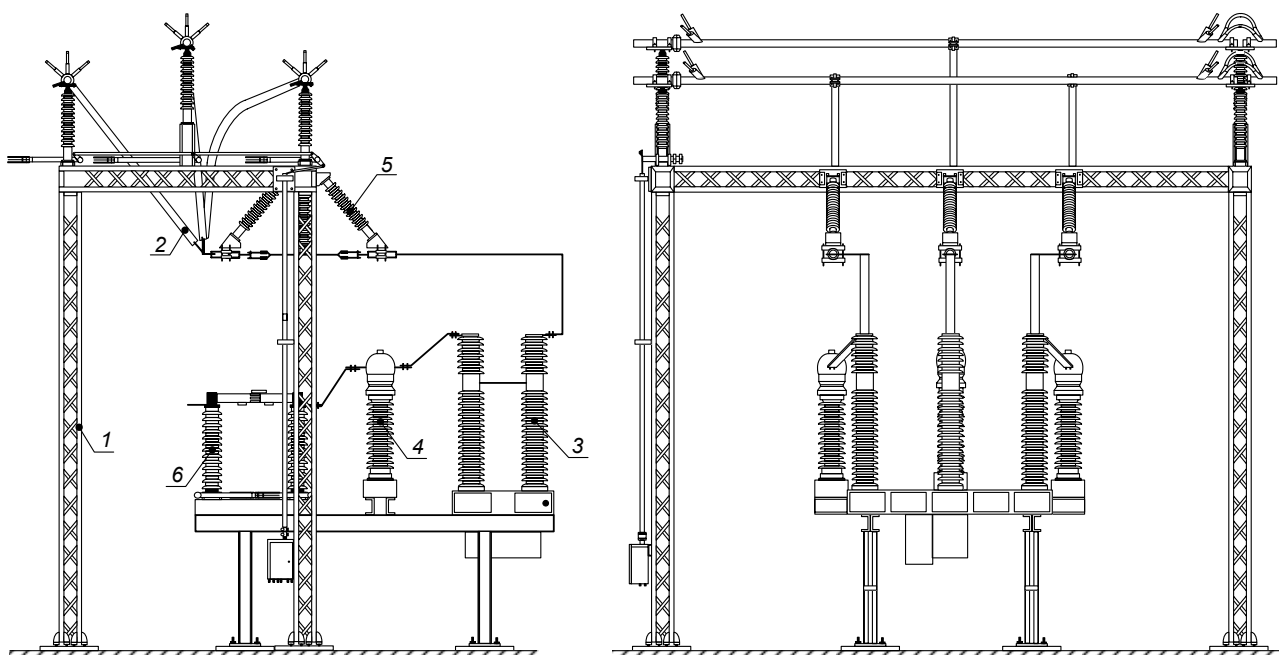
Компактный модуль открытого распределительного устройства КМ-ОРУ-110 с вакуумным выключателем: 1 – опорные металлоконструкции; 2 – жесткая ошиновка; 3 – вакуумный выключатель ВБП-110; 4 – трансформатор тока; 5 – шинный разъединитель; 6 – линейный (трансформаторный) разъединитель
